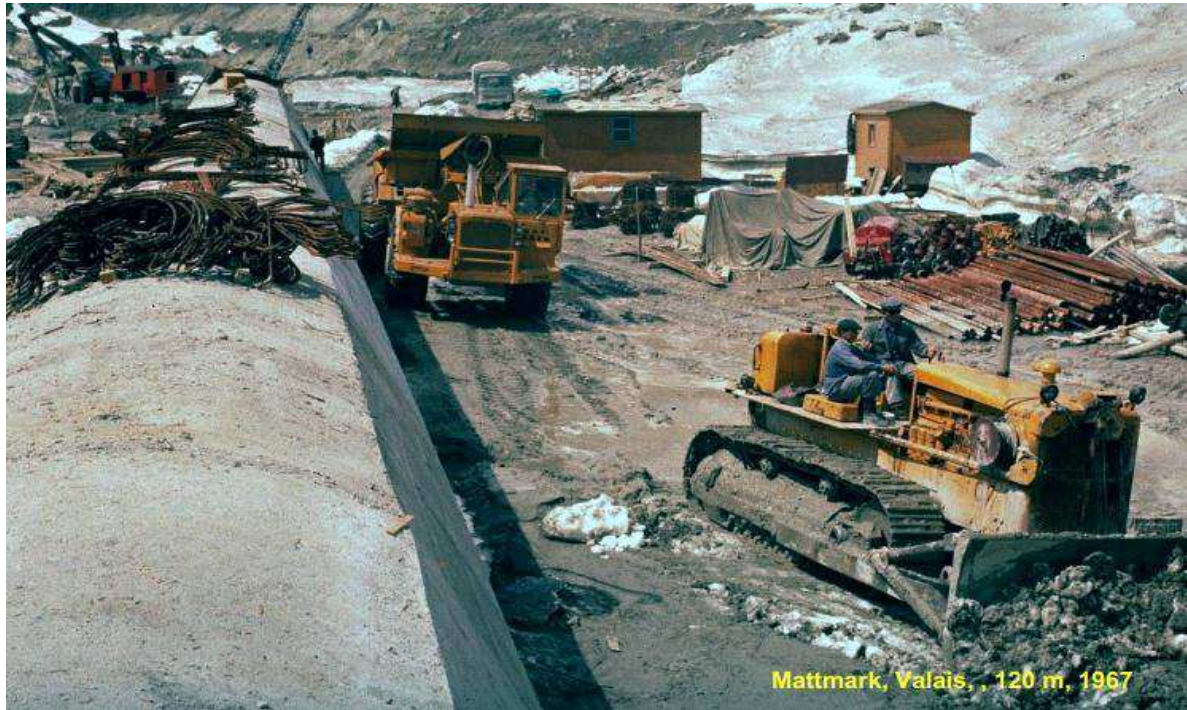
Construction d'une dérivation provisoire (barrage de Valais, Suisse)
